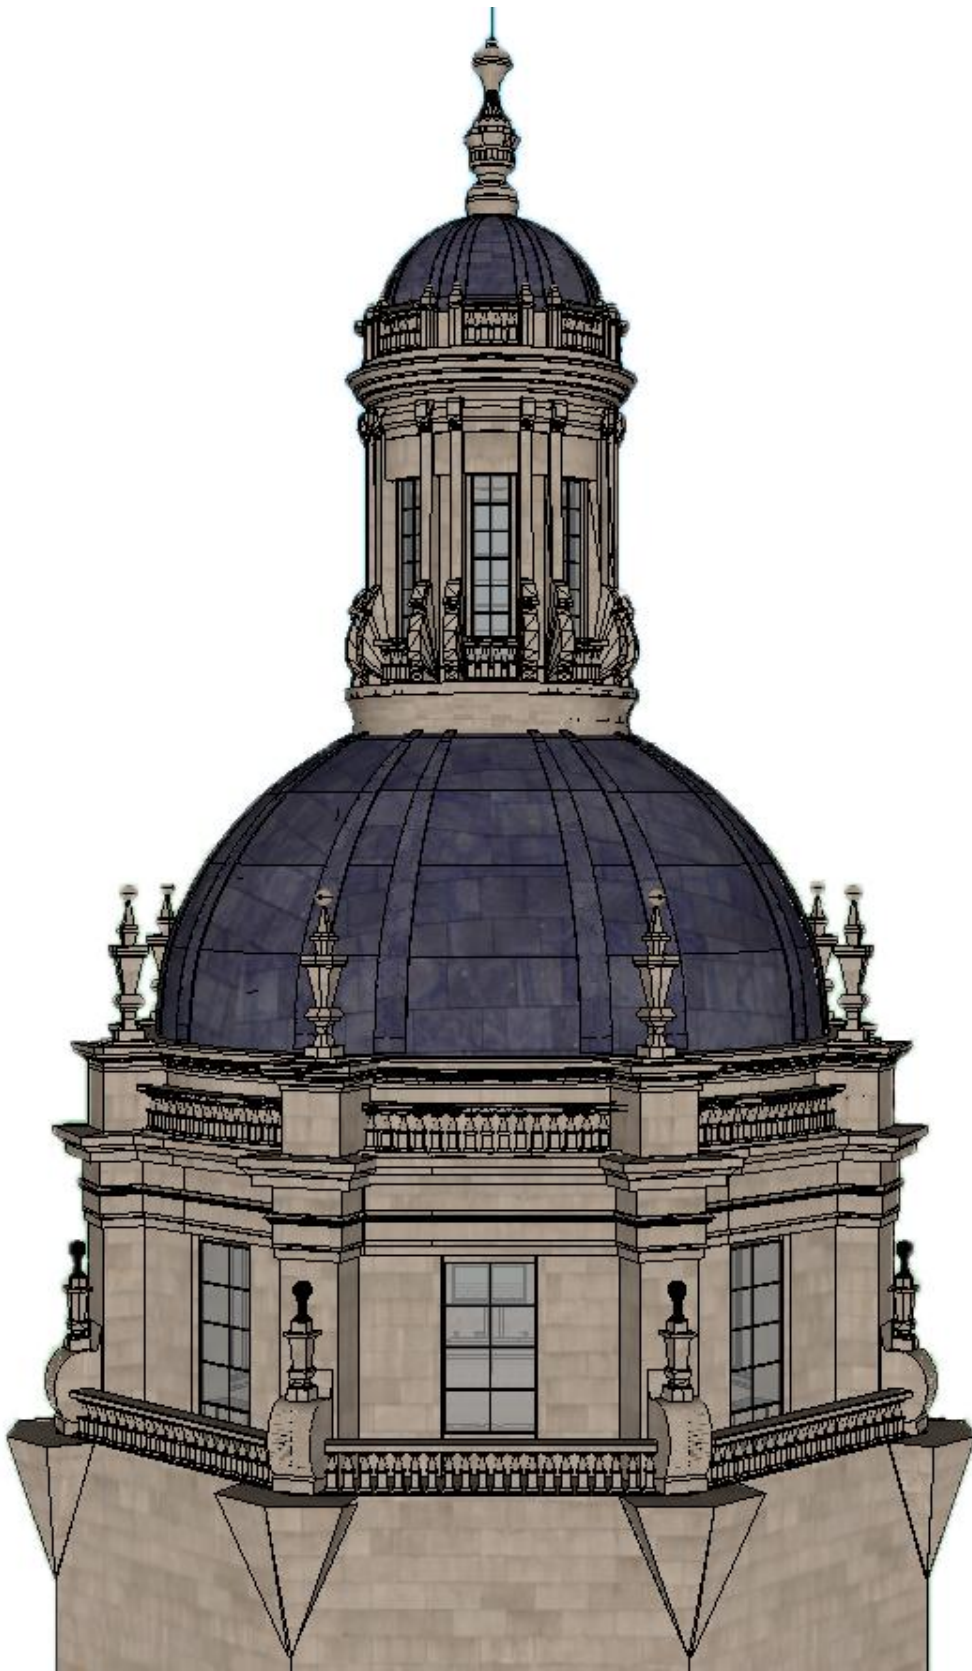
Volumetría con texturas de la cúpula en vista alzado. Elaboración propia.
